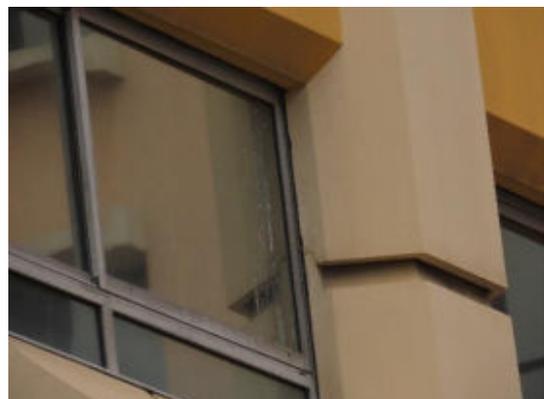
Stade Louis II, fissure et traces d'occupation © G. Beaudoin - CEN PACA
